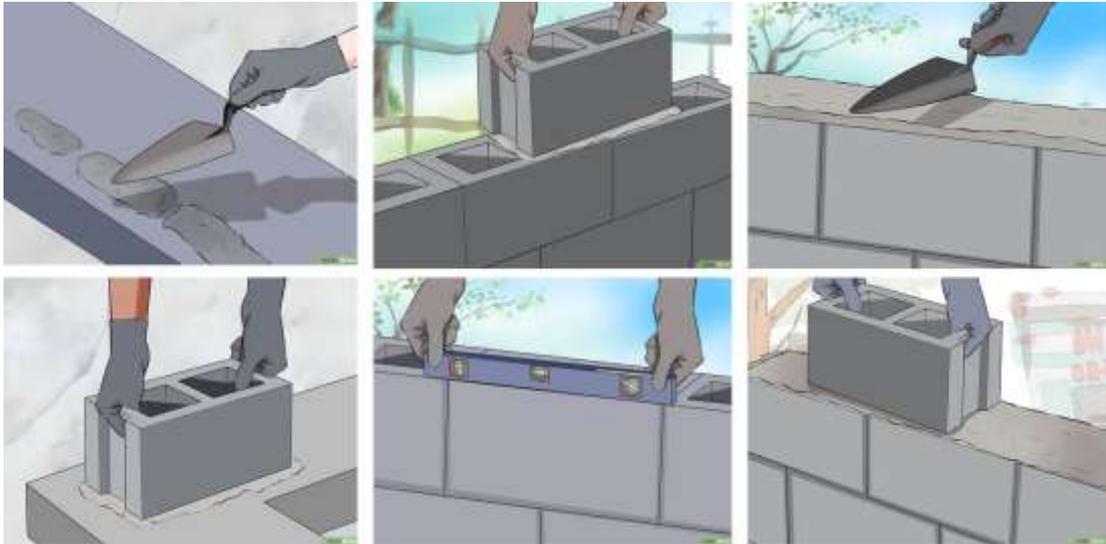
Proceso constructivo de Mampostería Tradicional.
